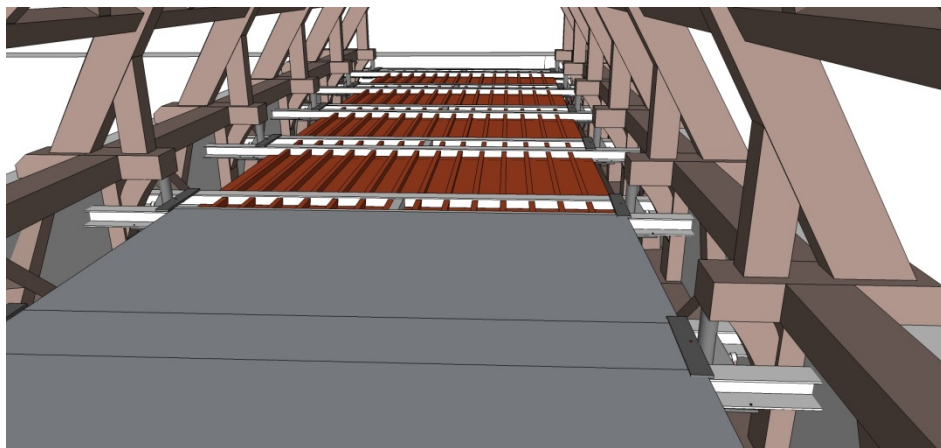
La dalle qui vient couvrir le coffrage et les poutres.
